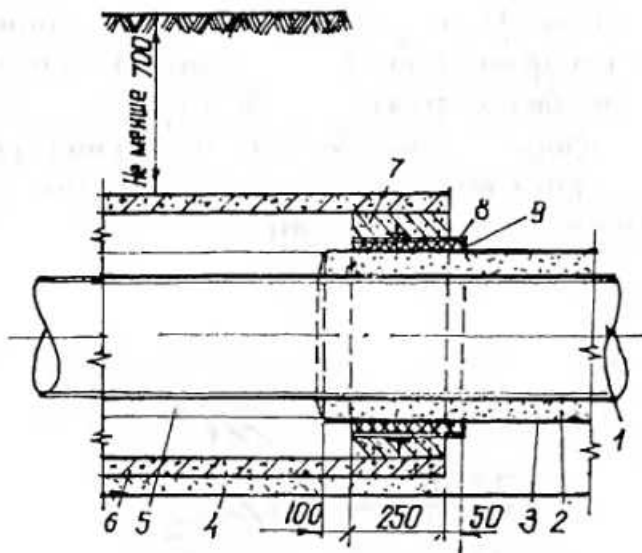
Поєднання безканалнього прокладання з каналньою ділянкою тепломережі: 1 - протикорозійна ізоляція; 2 - монолітна теплоізоляція; 3 - гідроізоляційне покриття; 4 - піщана основа; 5 - навивна теплоізоляція; 6 - залізобетонний канал; 7 - бетон; 8 - сталева гільза; 9 - просмолене ключчя
